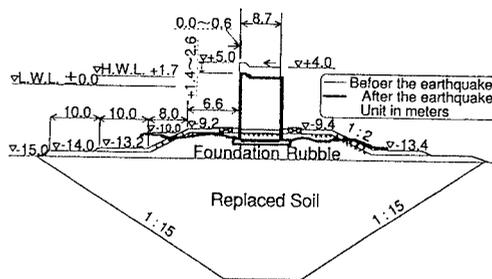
ケーソン式防波堤の標準断面と被災状況 (第七防波堤)
